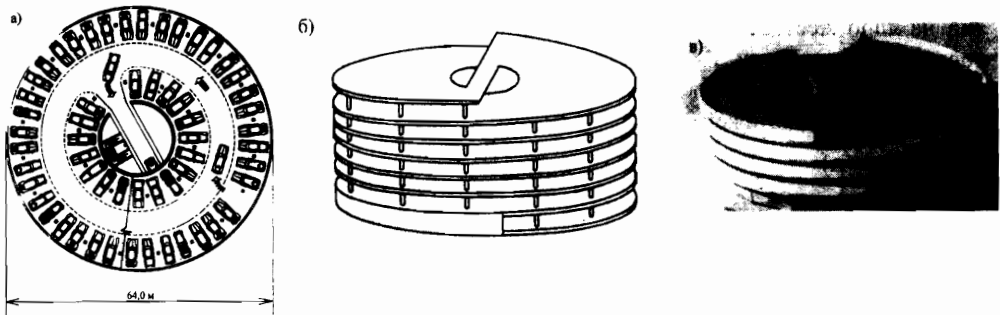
Пример возведения гаража-стоянки на 350 маш/мест методом подъема перекрытий: а - план типового этажа; б, в - общая схема и внешний вид гаража-стоянки
